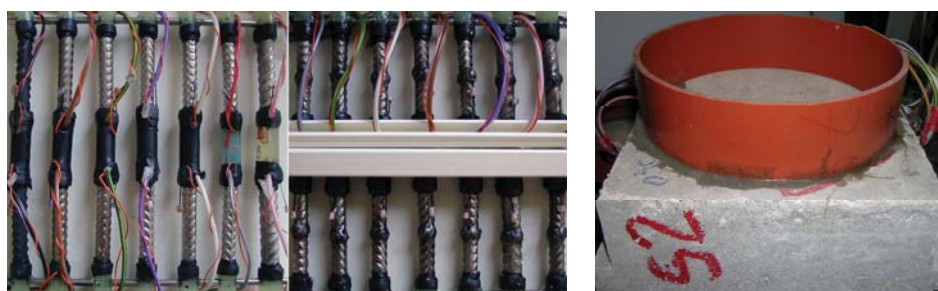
Detalhes da preparação das lajetas de betão com amostras das ligas em estudo.
